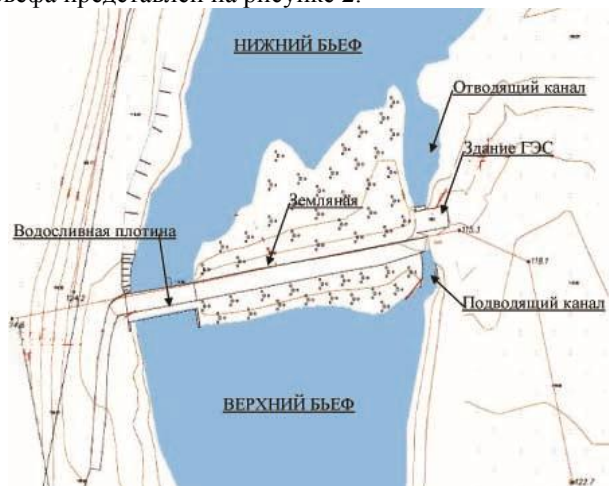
План гидроузла в с. Полонистое на р. Ятрань
